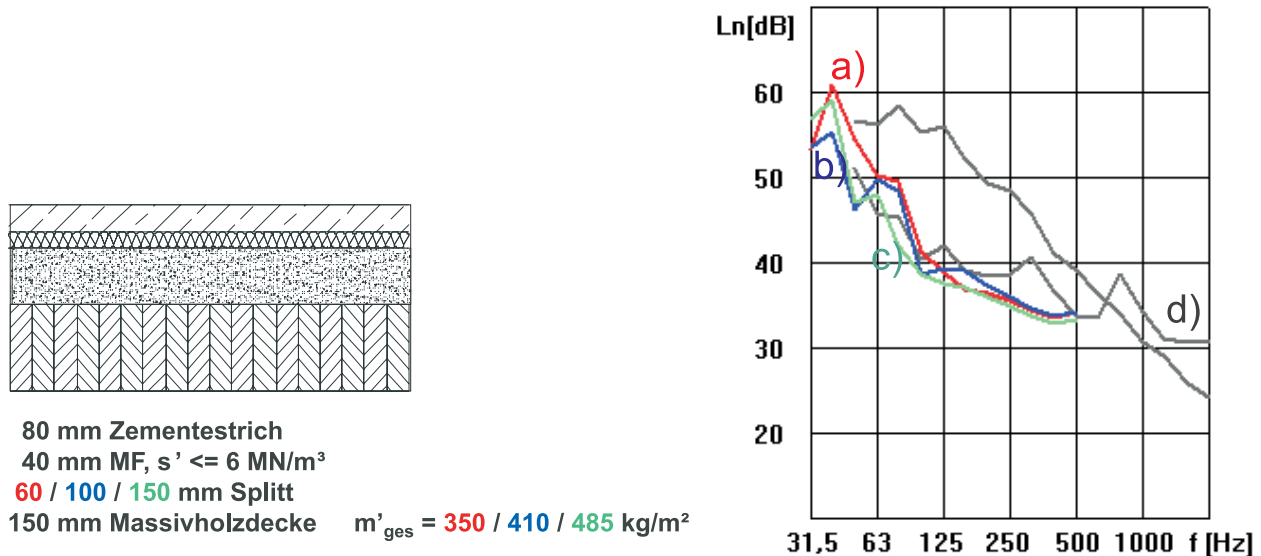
Vergleich unterschiedlicher Beschwerungsmassen: a) Berechnung mit 60 mm Kalksplitt b) Berechnung mit 100 mm Kalksplitt c) Berechnung mit 150 mm Kalksplitt d) Messwerte für Zementestrichaufbau auf einer 160 mm Stahlbetondecke
